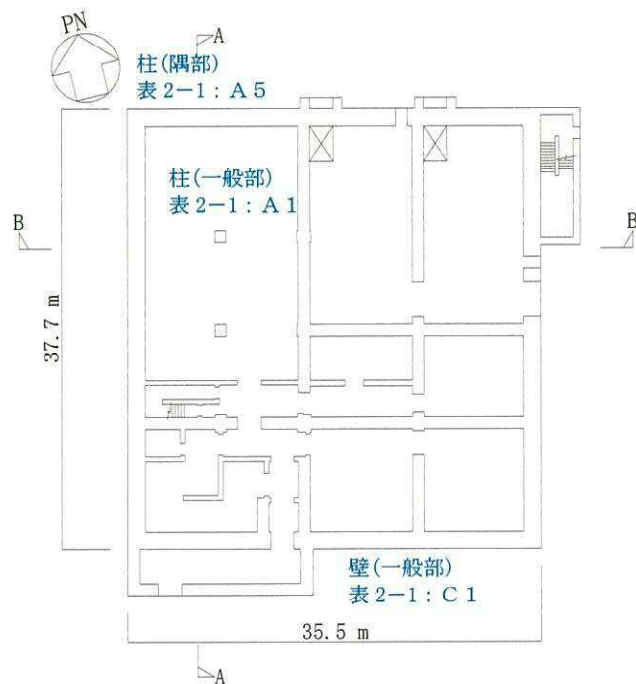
緊急時対策所建屋の概略平面図 (EL. 23.3 m)
